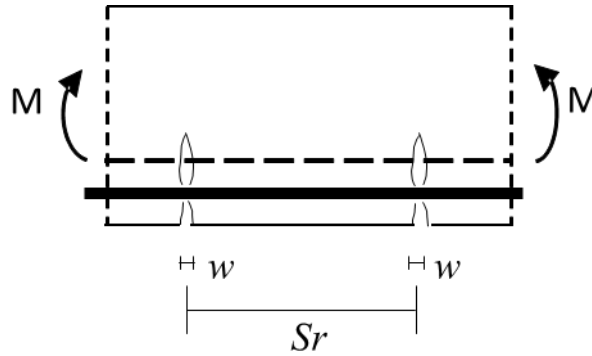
Fisuración por flexión en un elemento de hormigón.
